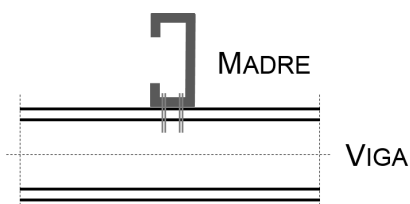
Contraventamento lateral do banzo superior da Viga B.
